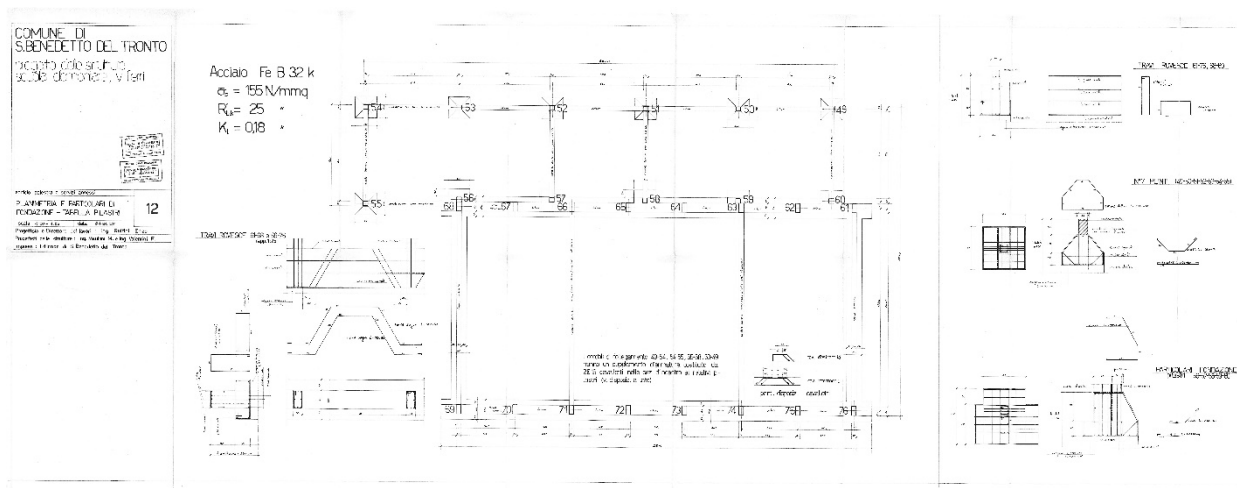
Tavola progetto – Carpenteria fondazione Corpo C
